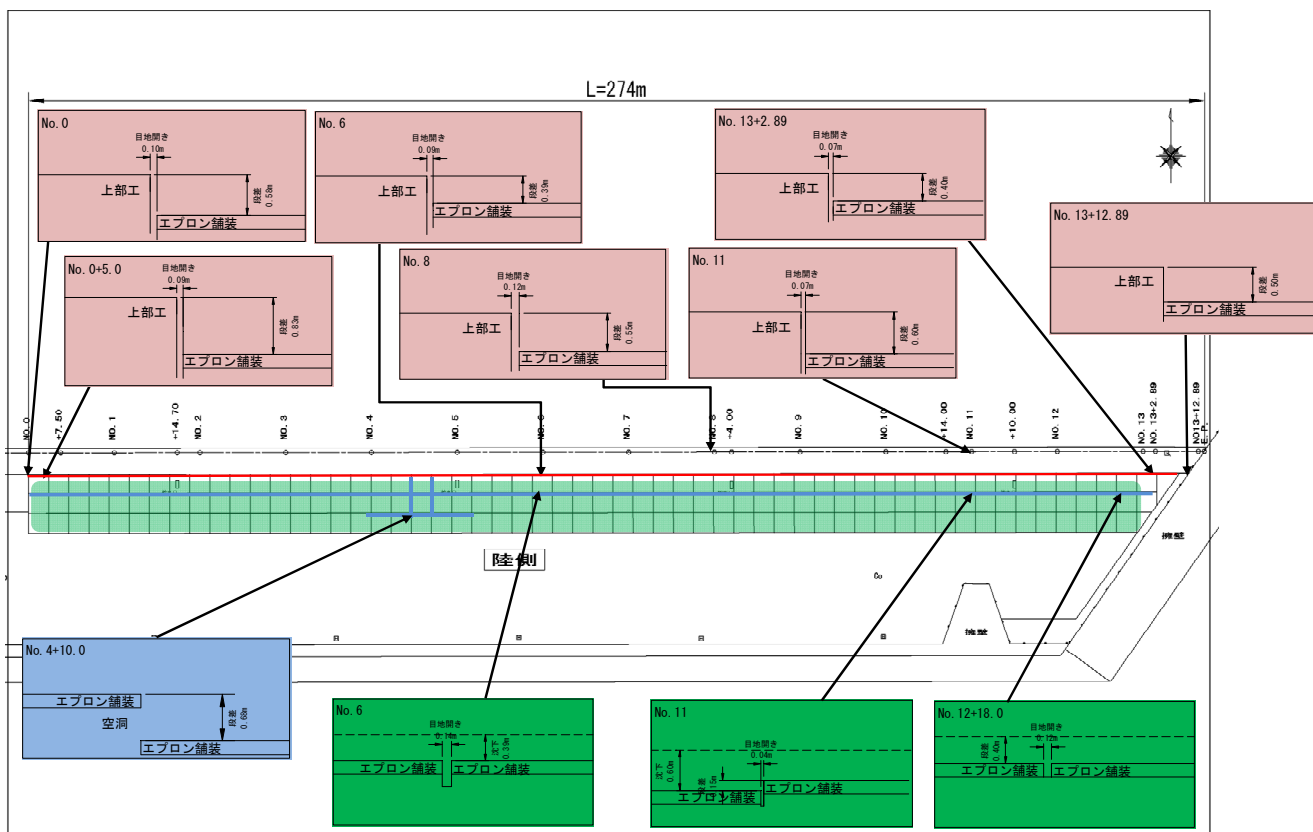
No.23 常陸那珂港区\_南ふ頭地区 C 岸壁 (-7.5m) の平面図 (被災後)
